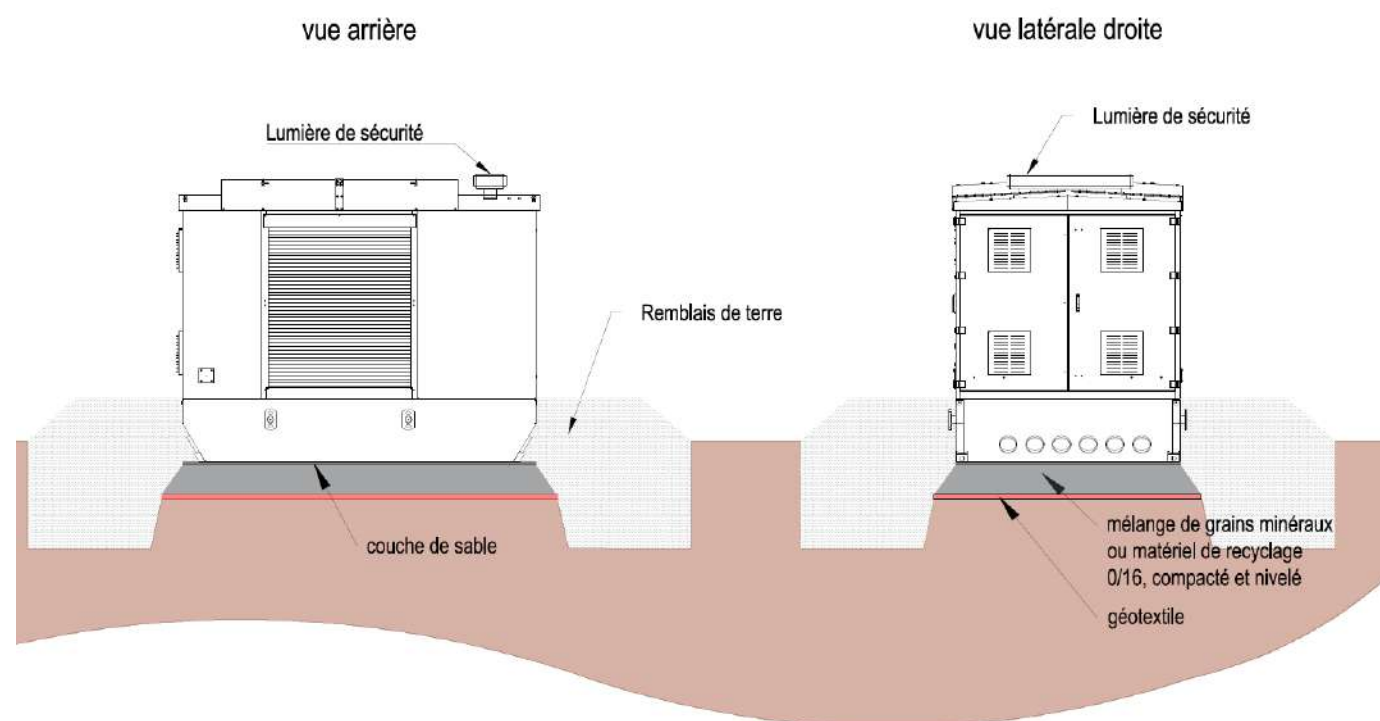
Vues des façades et d'un poste de transformation prévu sur site (source : BayWa r.e.)
